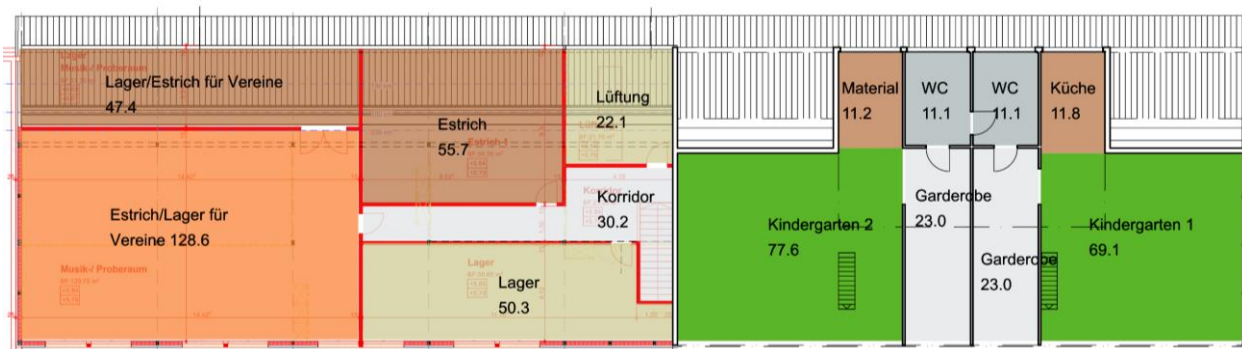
Grundriss mit den heutigen Nutzungen des Dachgeschosses der Turnhalle Zelgweg.
